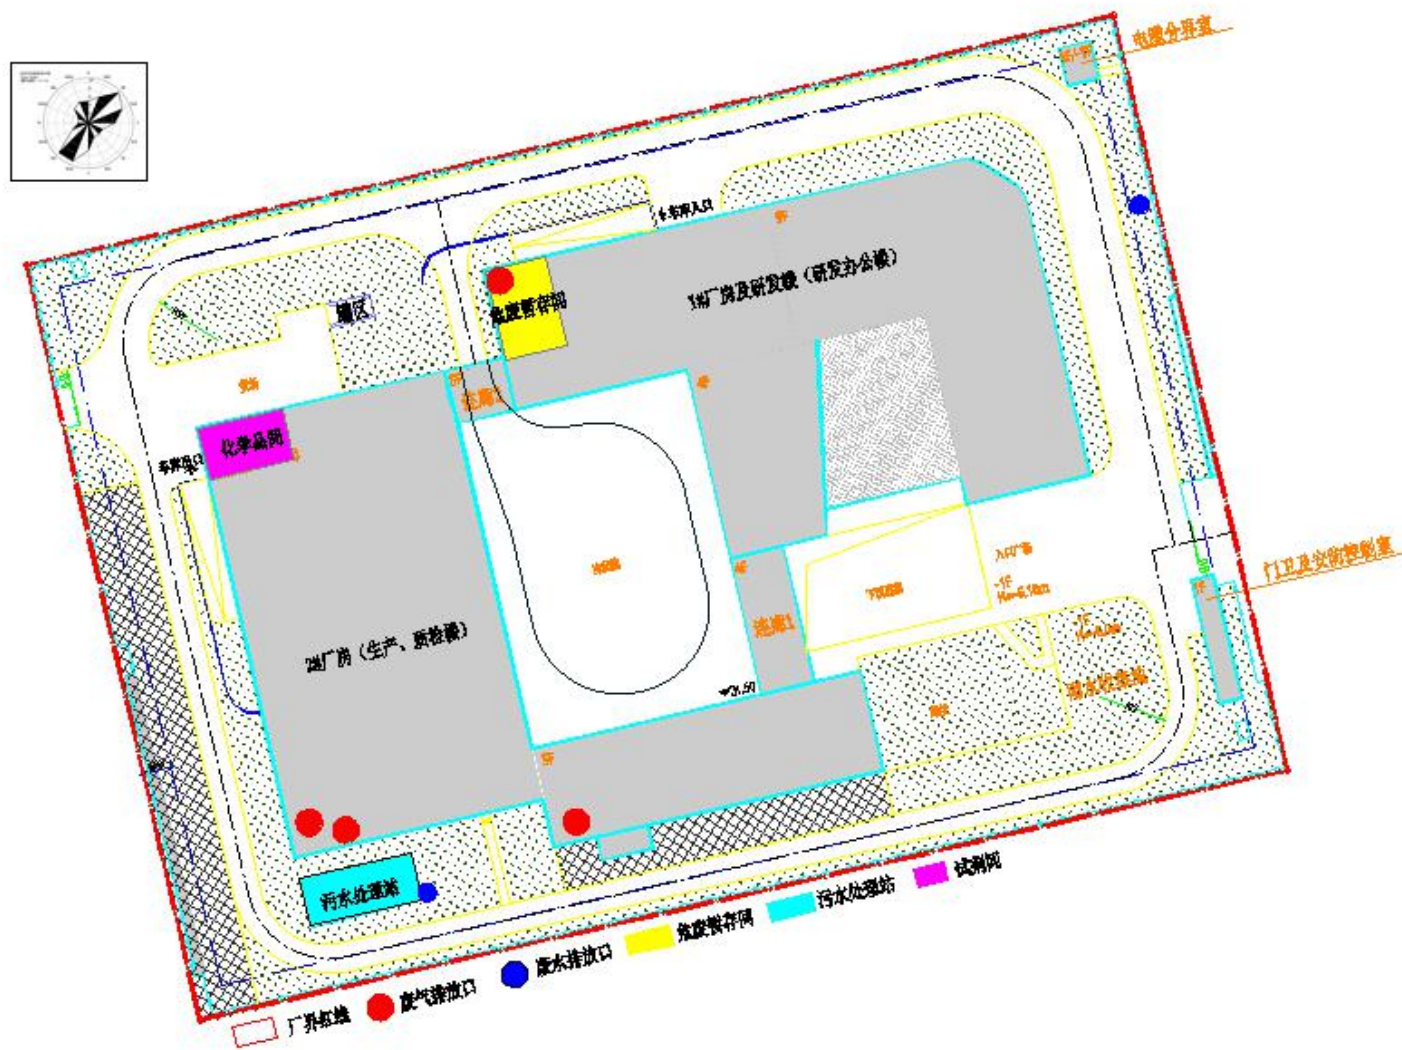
项目厂区总平面布置及主要排污口位置图
